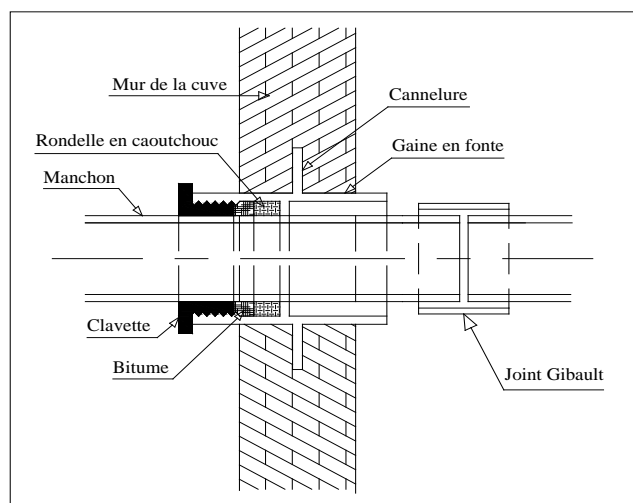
Traversée des conduites (Gaine en fonte)
